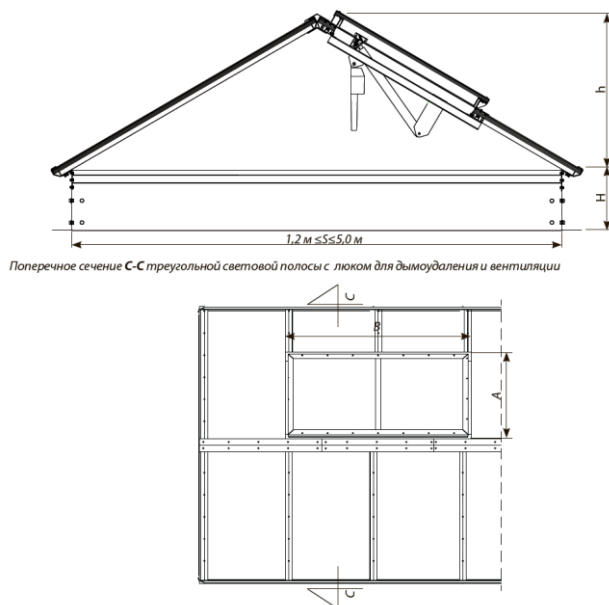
Поперечное и продольное сечение стандартной конструкции треугольной световой полосы.
